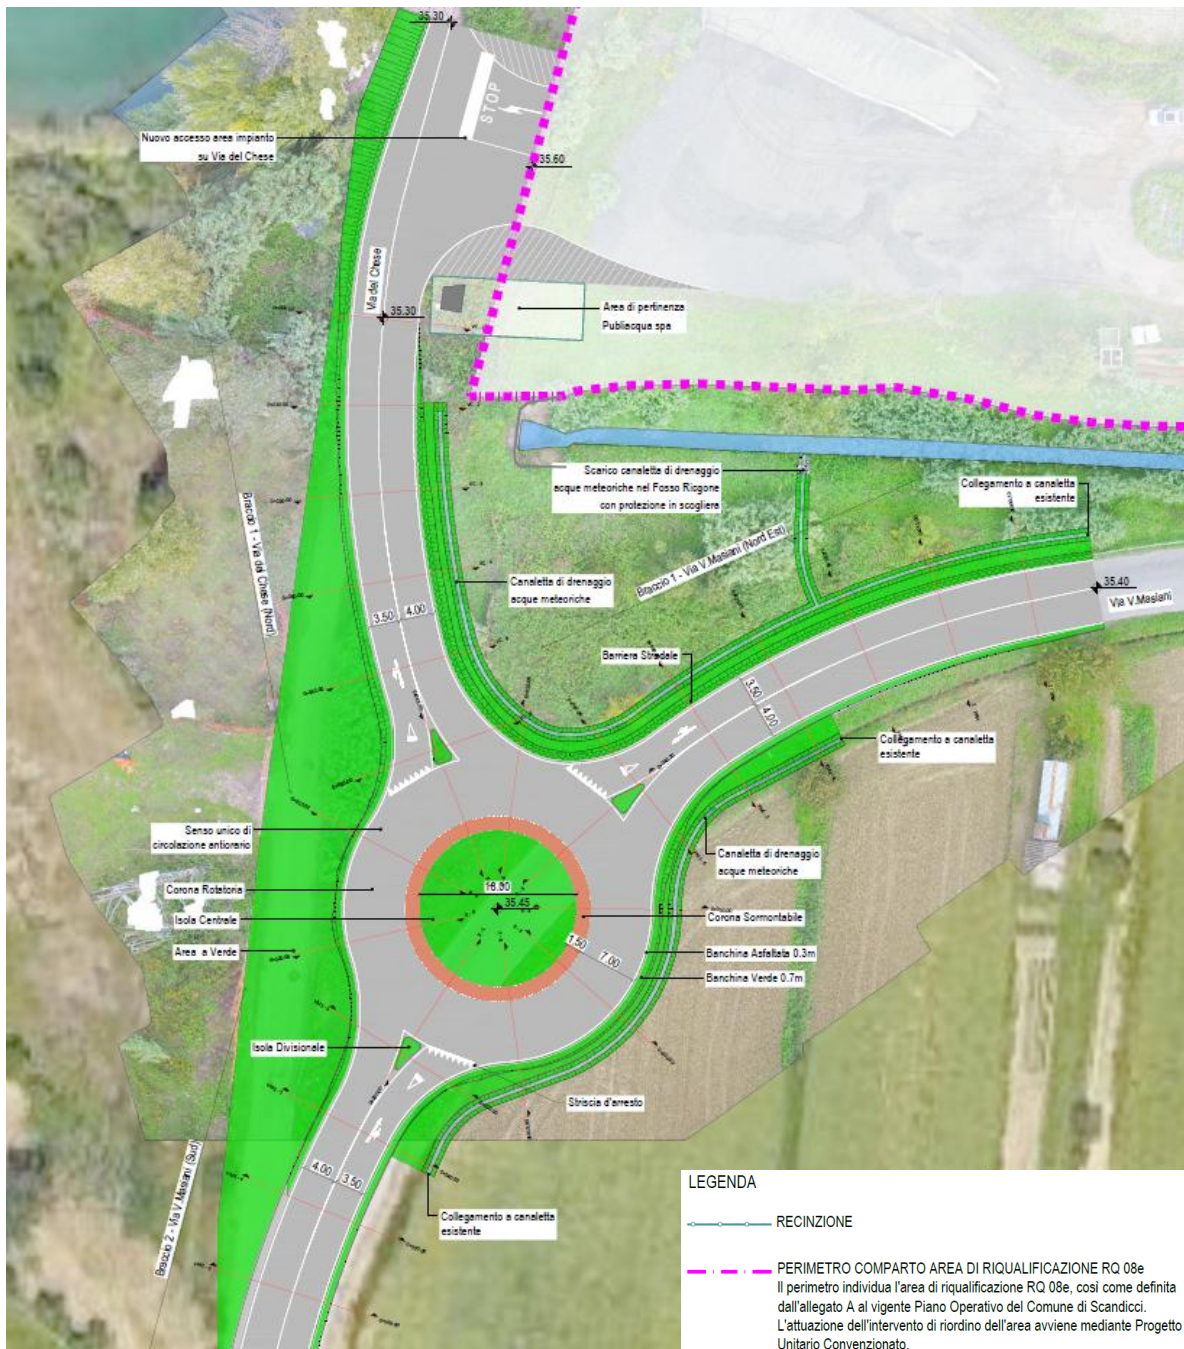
Nuova rotonda, planimetria di dettaglio
